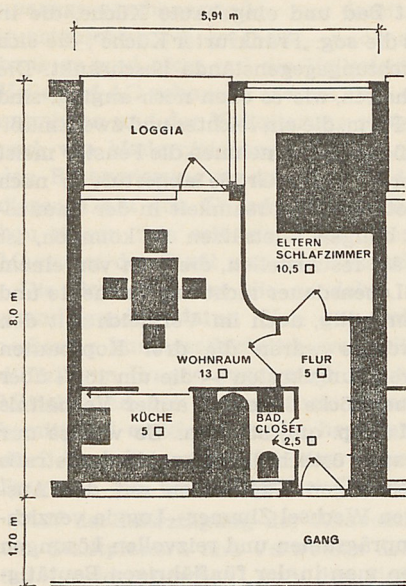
Abb. A Grundriß einer Kleinstwohnung in den Kopfbauten an der Frankenallee, Obergeschoß. Unten (Norden): der Laubengang. Oben (Süden): die Front zur Frankenallee (Aus: „Das Neue Frankfurt“ IV, 1930, Heft 4—5, S. 127.)
